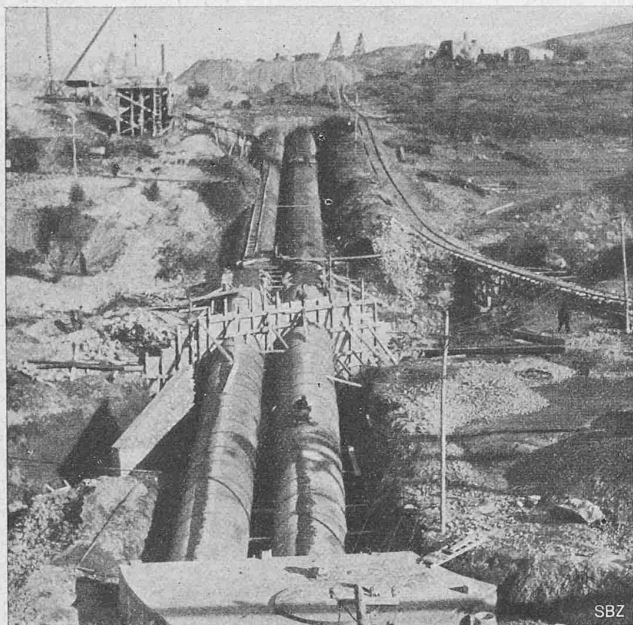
Einbetonieren der untern Rohrleitungsstrecke.
